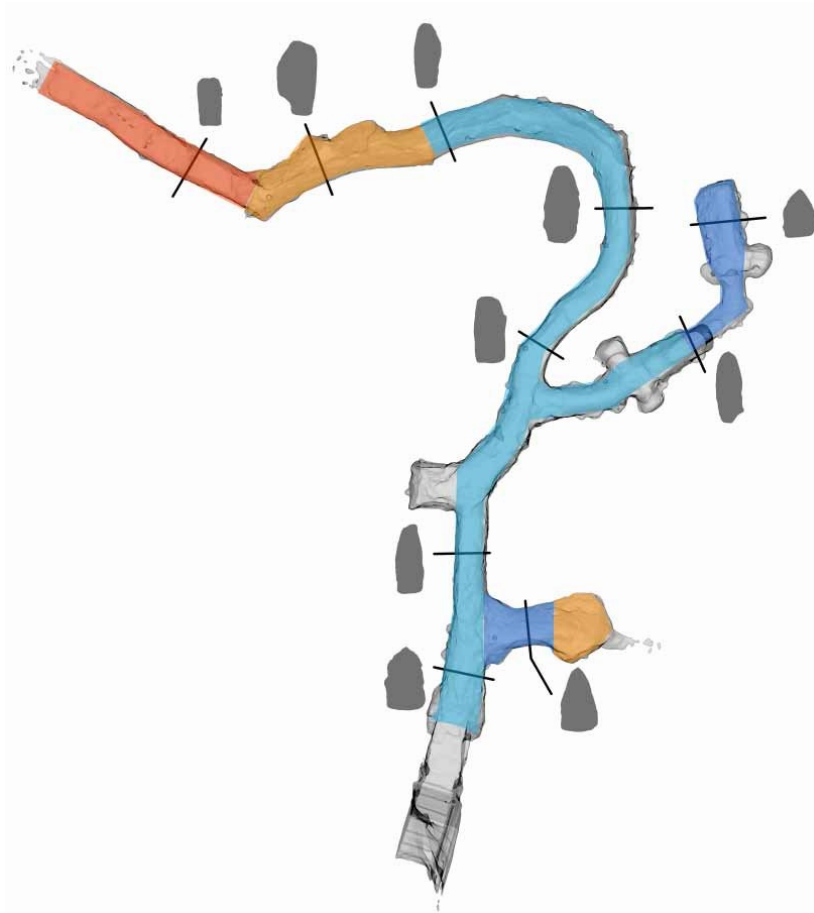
Grundriss (genordet) des Erdstalls, mit eingezeichneten Gangprofilen (Querschnitten) an den durch Linien markierten Stellen.
